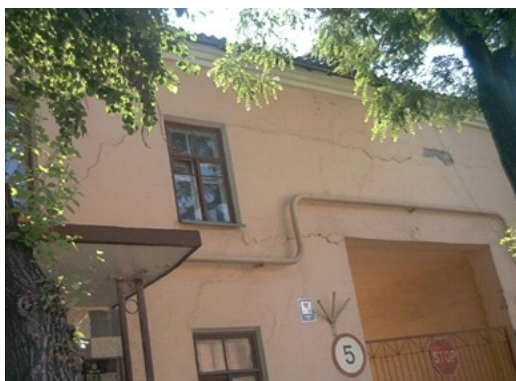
Здание АОЗТ ДПТП «Донбасс» в г. Донецке. Наклонные и горизонтальные трещины в стенах по главному фасаду.
